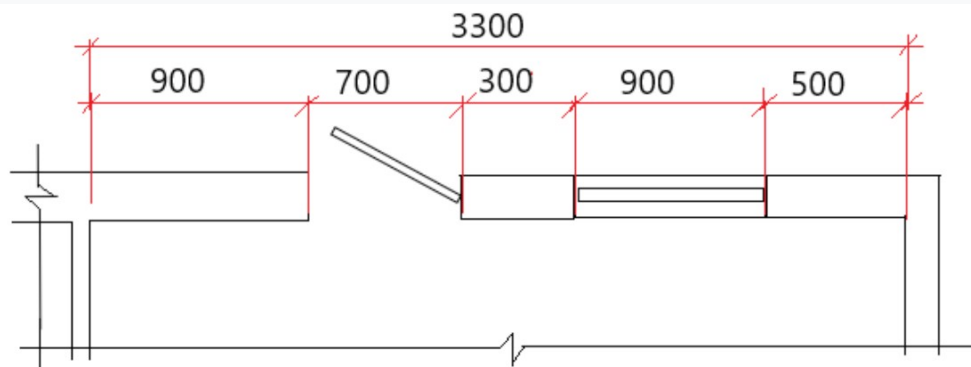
Нанесення розмірів фрагменту плану на кресленні
